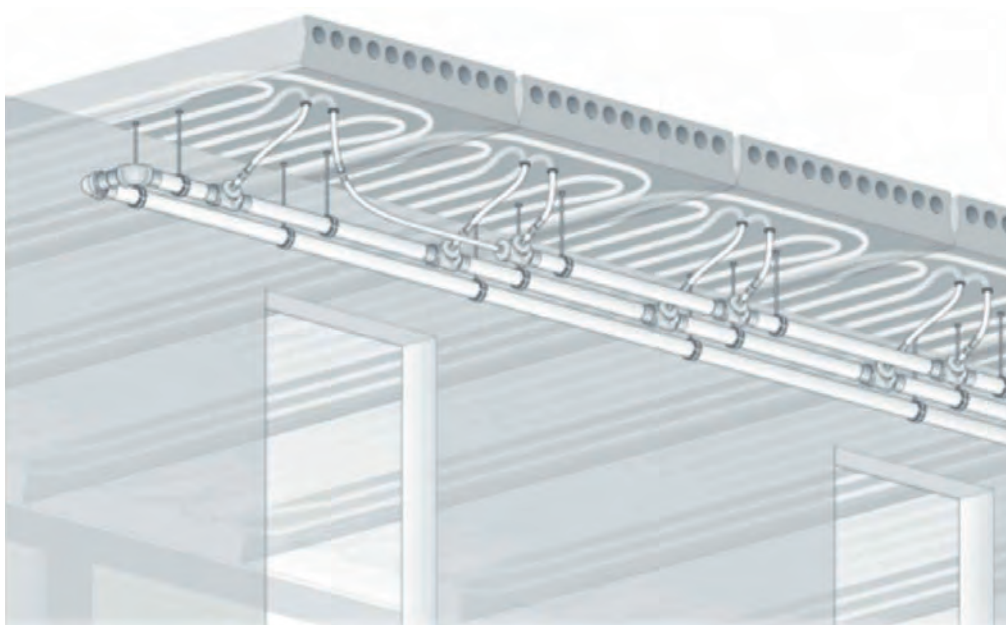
Losas macizas de hormigón prefabricadas para Forjados Activos.
